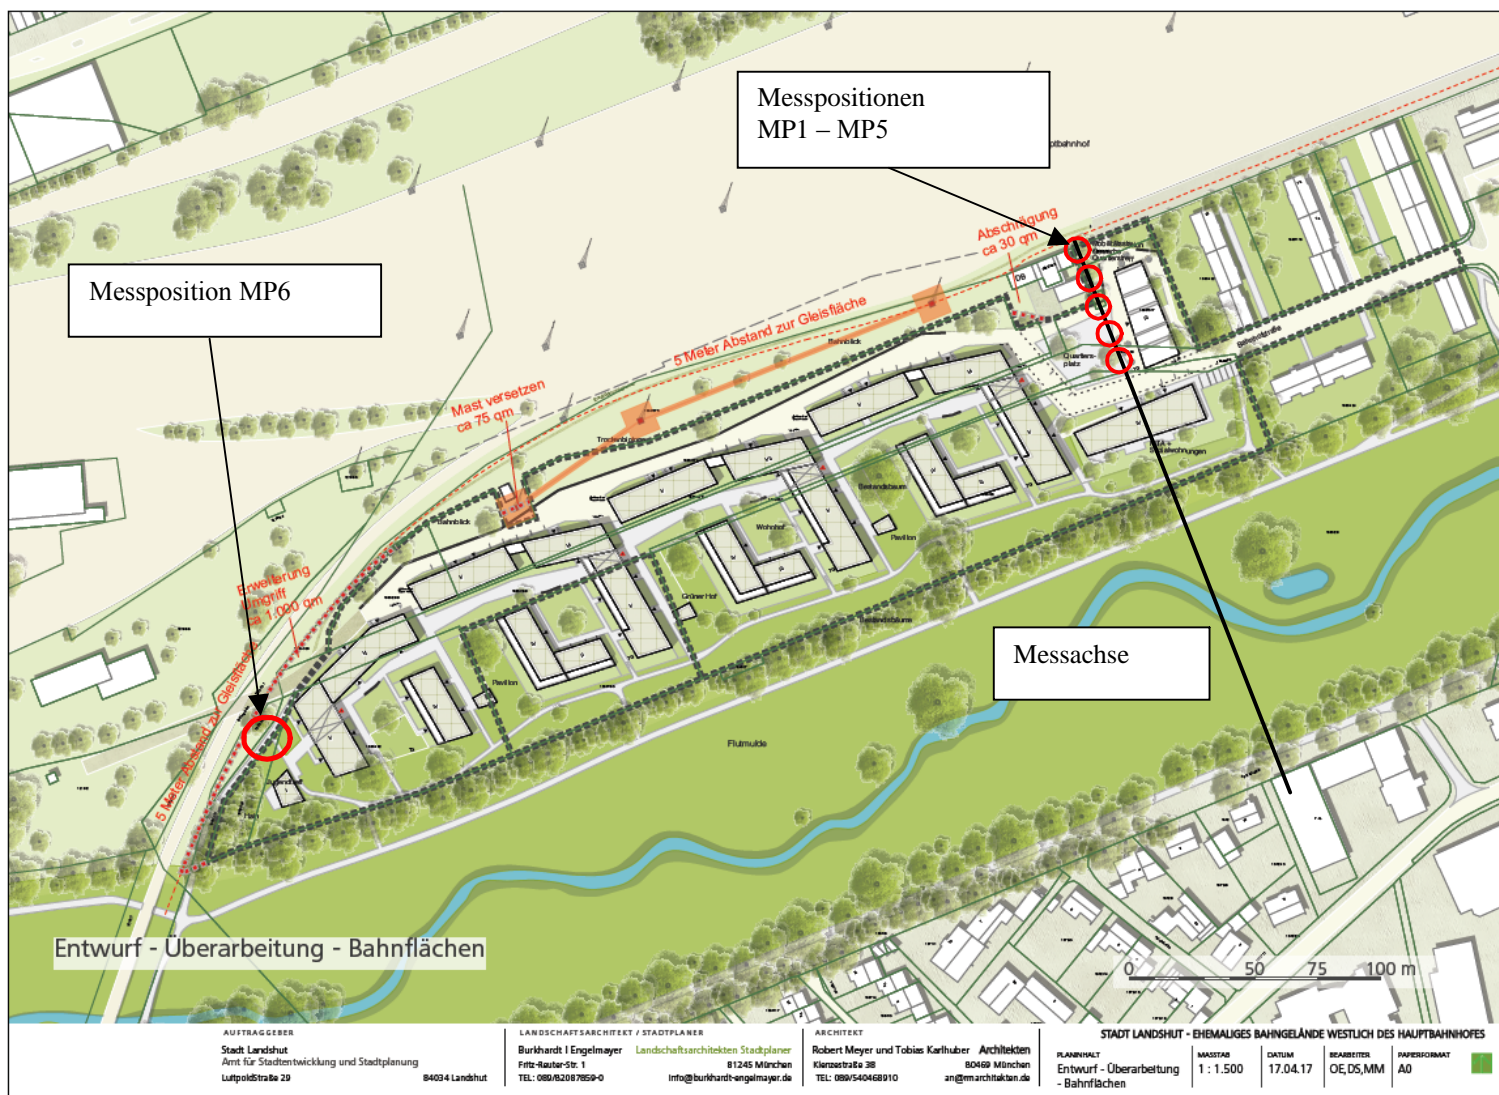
Lage der geplanten Bebauung mit Bahntrasse und Messachse
